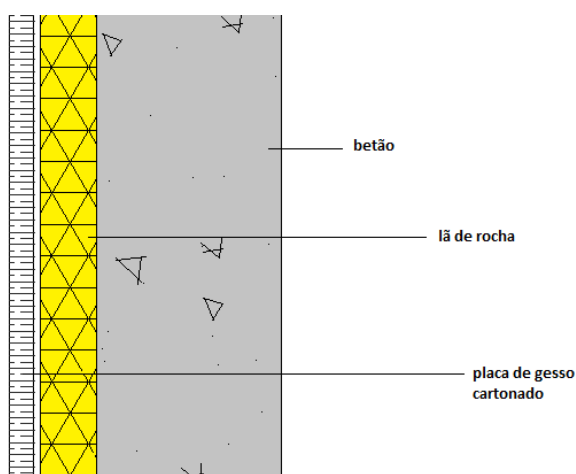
Pormenor da parede de separação entre a habitação e caixa de escadas
